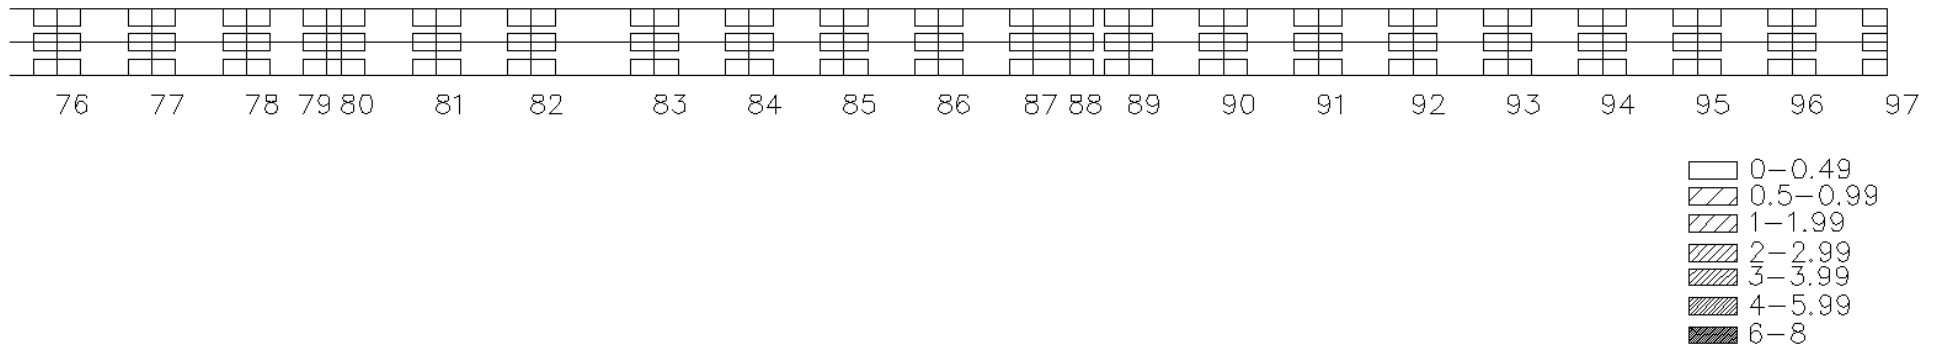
Frästiefen bei Tangenten und quadratischen Parabeln und Verfahrensplan Typ V, Grundriss, Stationen 76-97
